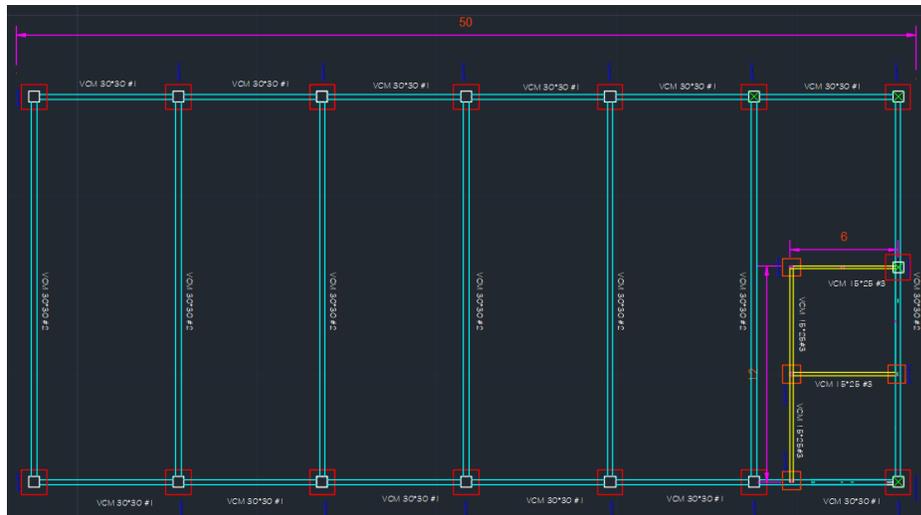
Detalle de zapatas Fuente: Elaboración propia
